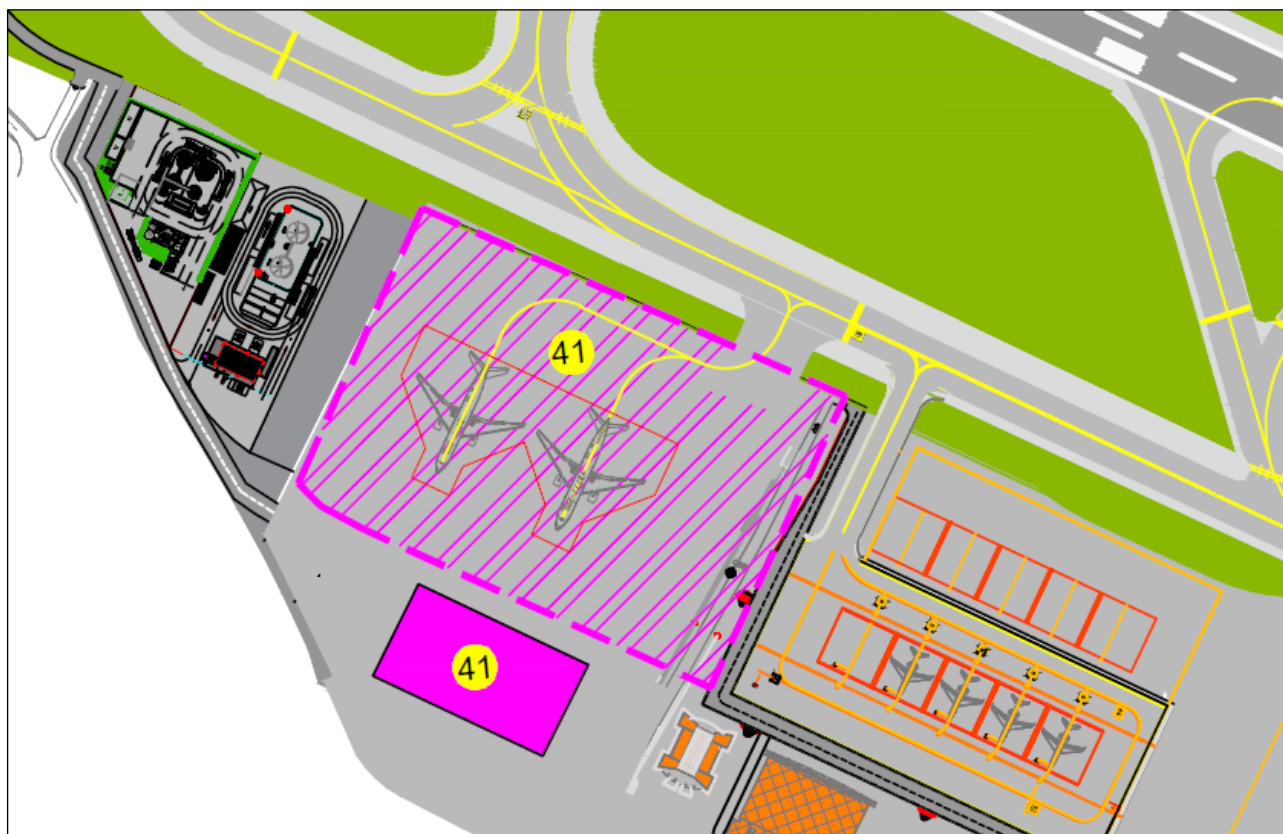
Estratto Master Plan – Nuovo Piazzale Apron 5 e Edificio Cargo
